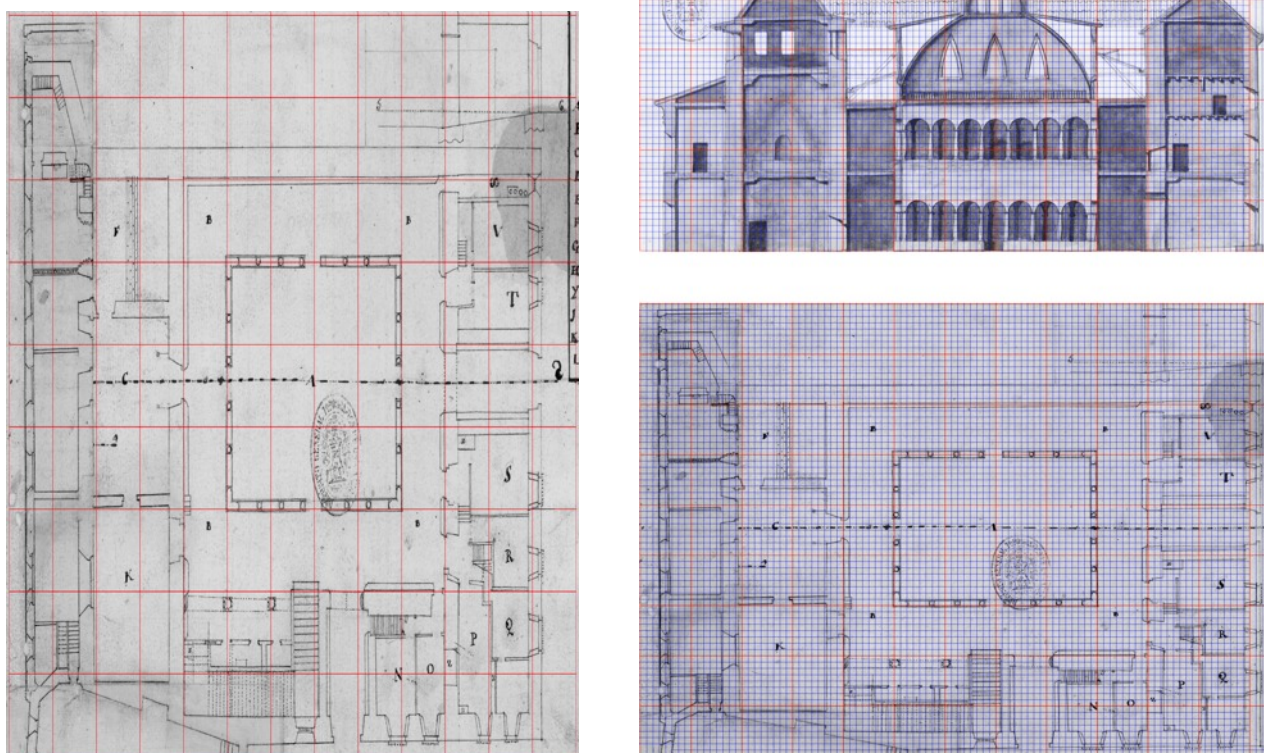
Planta y alzado del palacio según los planos de 1756. Modulaci3n identificada.
